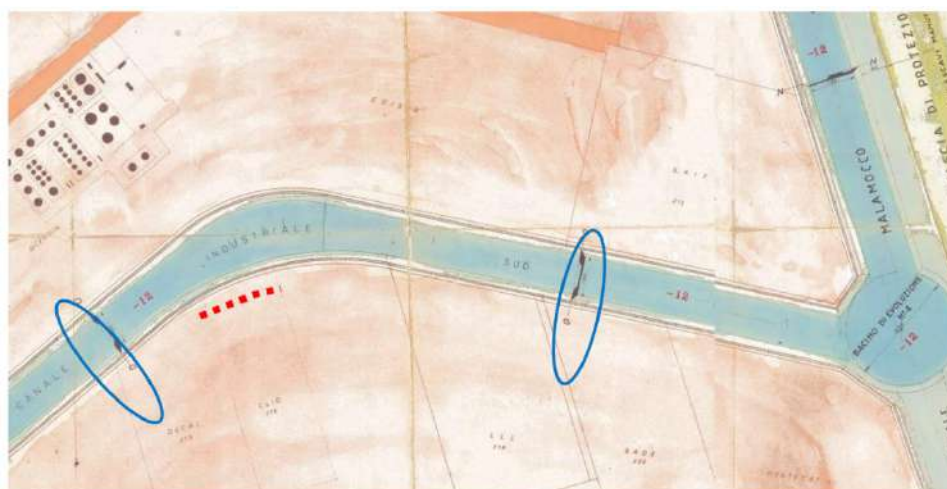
Planimetria PRP con evidenziate le sezioni == del canale industriale Sud (blu) e indicazioni della banchina oggetto di intervento (rosso)
